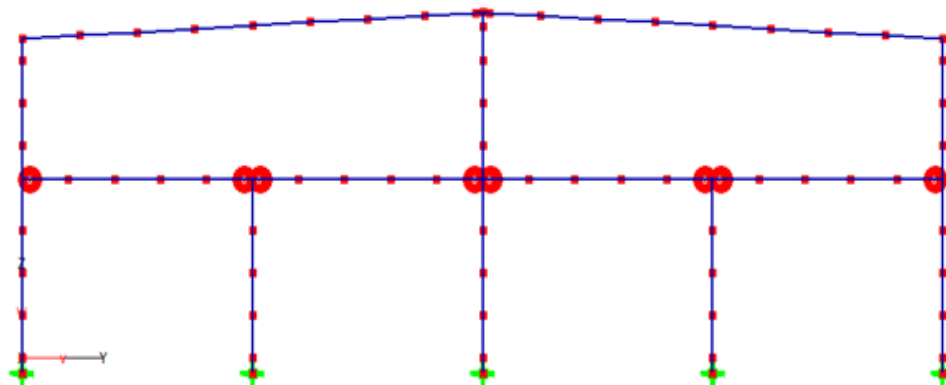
Схема сопряжения балок с колоннами и опорных закреплений
